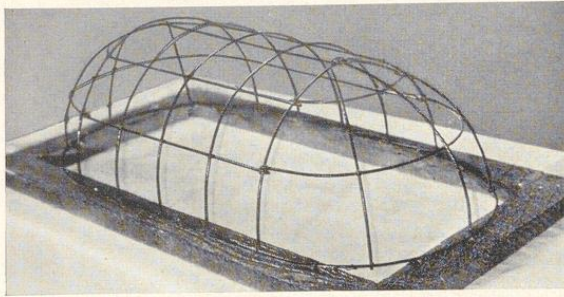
Muldengewölbe mit kreisrundem Abschluß, zum Aufsetzen auf eine Rabitzdecke
